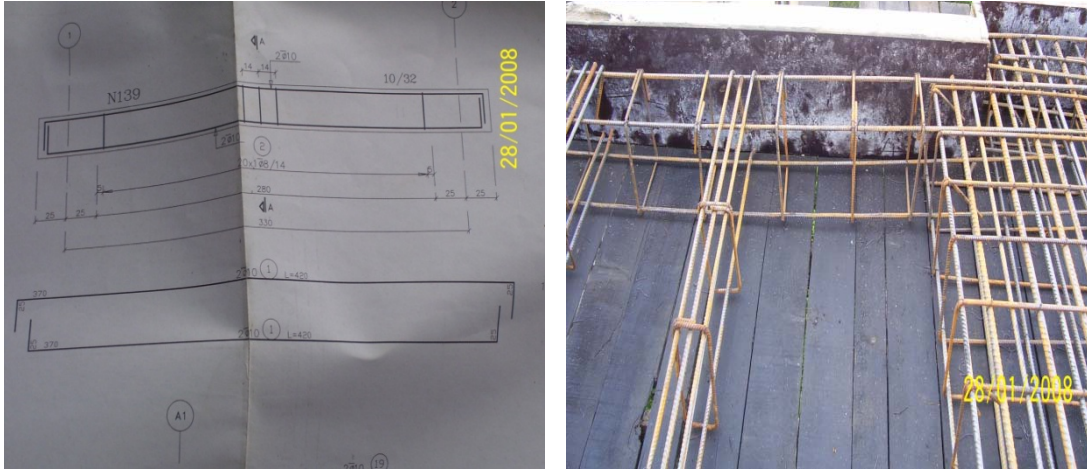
(a) Projede 90 derece kıvrılması istenen alt ve üst kiriş donatıları ve (b) uygulamada 90 derece kırılan üst donatılar
